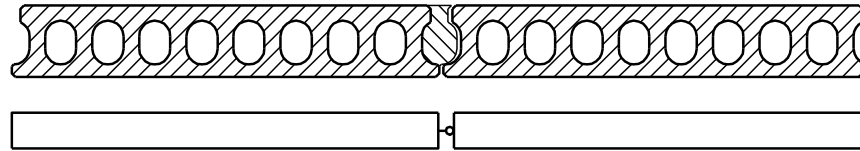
Esquema de junta fendilhada entre painéis.
